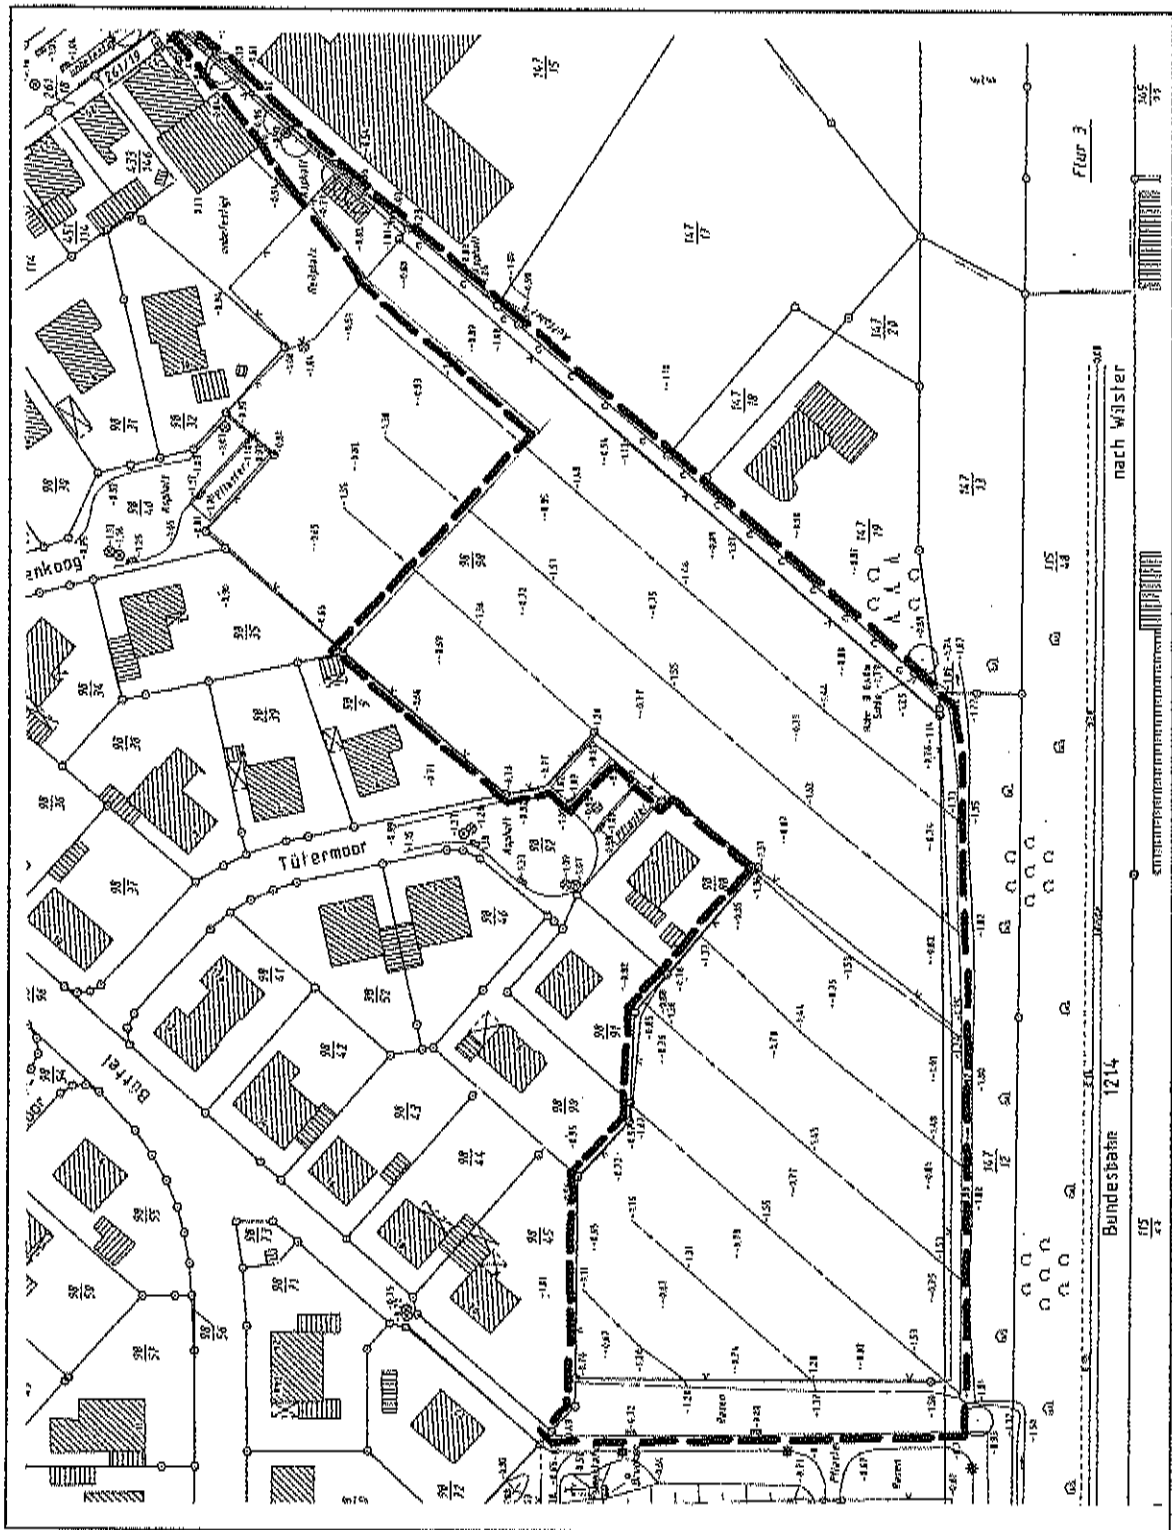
Plangebietsabgrenzung und Lage des Palngiebts im Raum, unmaßstäblich, auf Grundlage eines Lage- und Höhenplanes vom 29.01.1999
